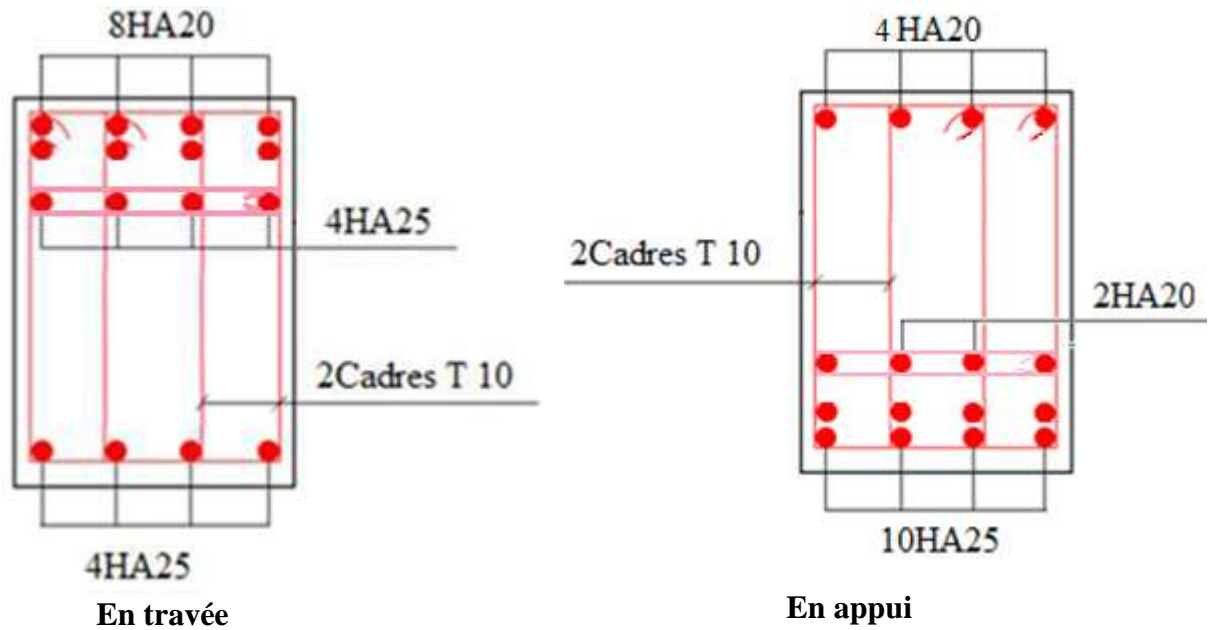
Schémas de ferrailages des nervures sens xx.
